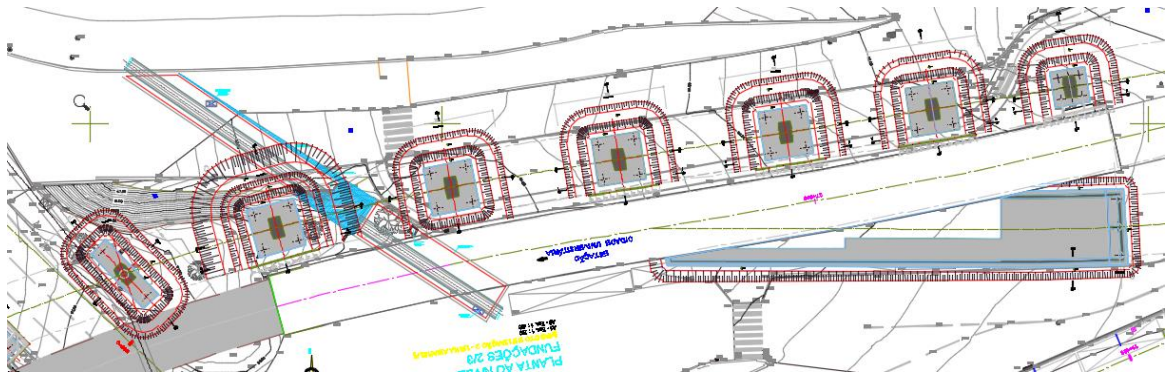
Planta da zona da galeria existente e do coletor com localização dos cortes
